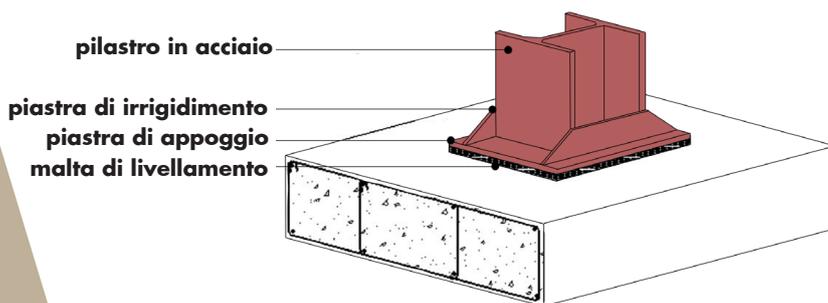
sezione sistema di ancoraggio, SCALA 1:10
